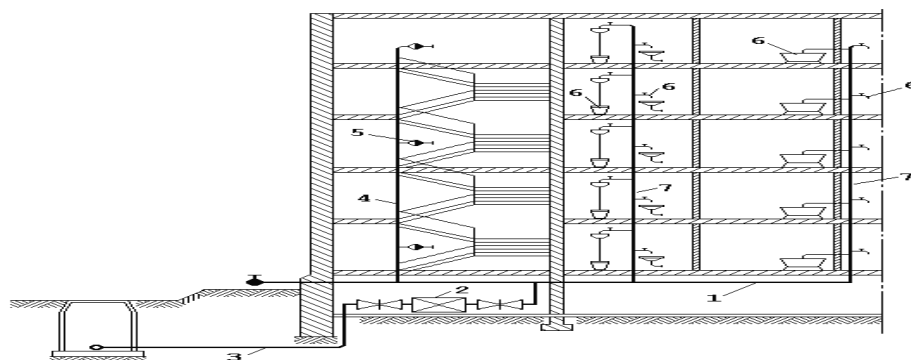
Элементы внутреннего водопровода: 1 – магистральный трубопровод; 2 – водомерный узел; 3 – ввод; 4 – распределительный пожарный трубопровод (стояк); 5 – пожарный кран; 6 – водозаборные краны и другие приборы; 7 – распределительный хозяйственно-питьевой трубопровод (стояк)
